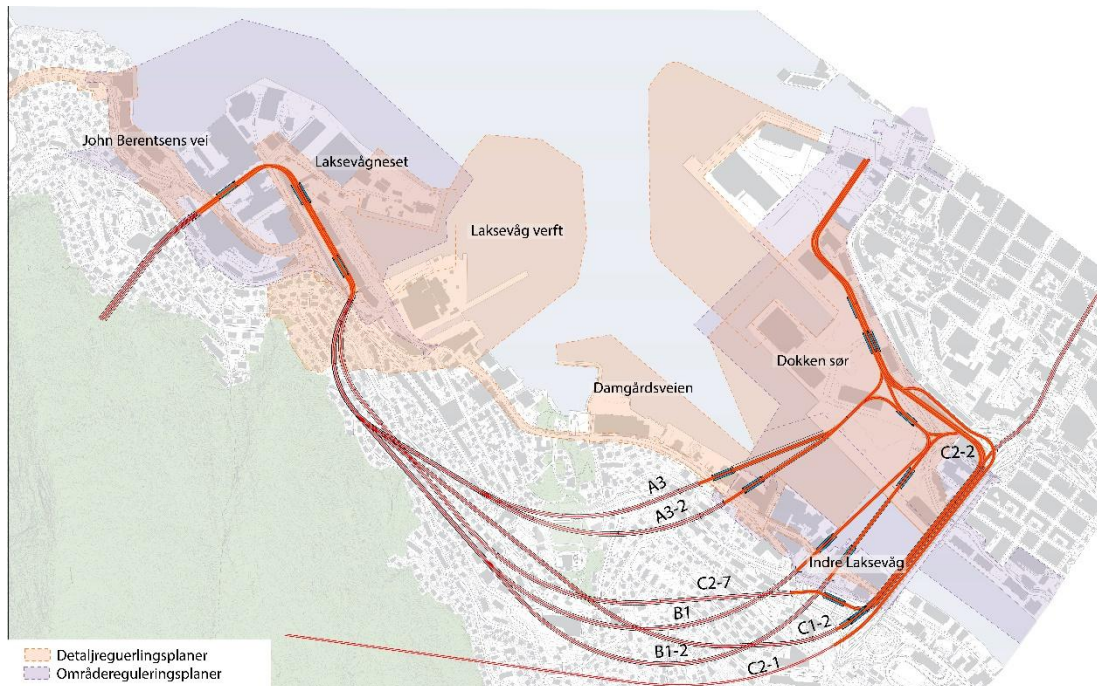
C-alternativer i dagen med pågående planer i bakgrunnen.
